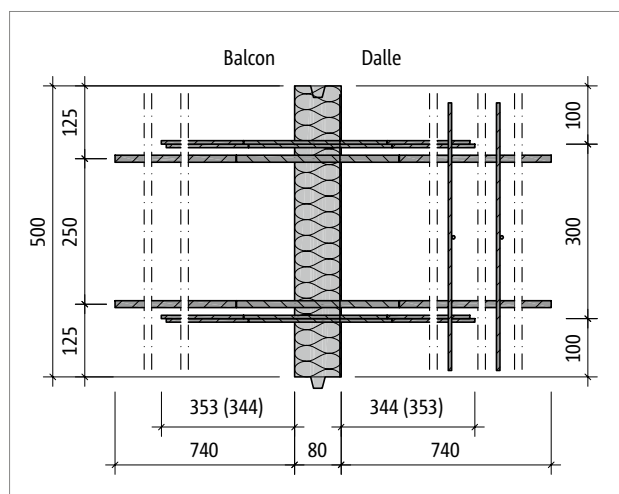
Schöck Isokorb® T type D-MM1-VV1 : plan de base
